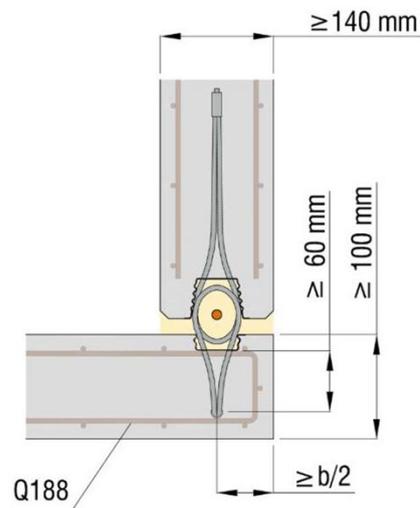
Wand - Wand – Eckverbindung - Detail mit reduzierter Zulagebewehrung
